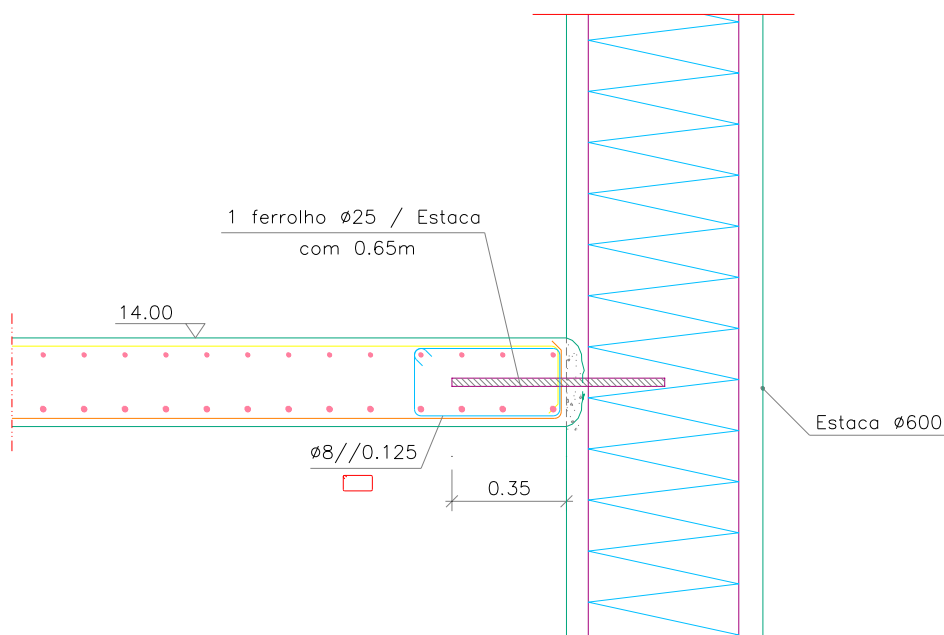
Pormenor de ligação das lajes à cortina de estacas no piso 0.
